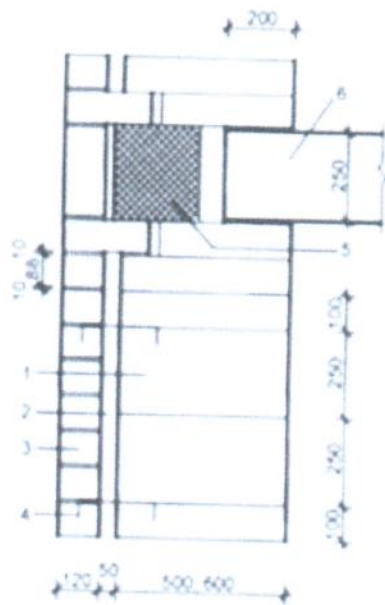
Наружная стена из ячеистобетонных блоков с облицовкой кирпичом:
